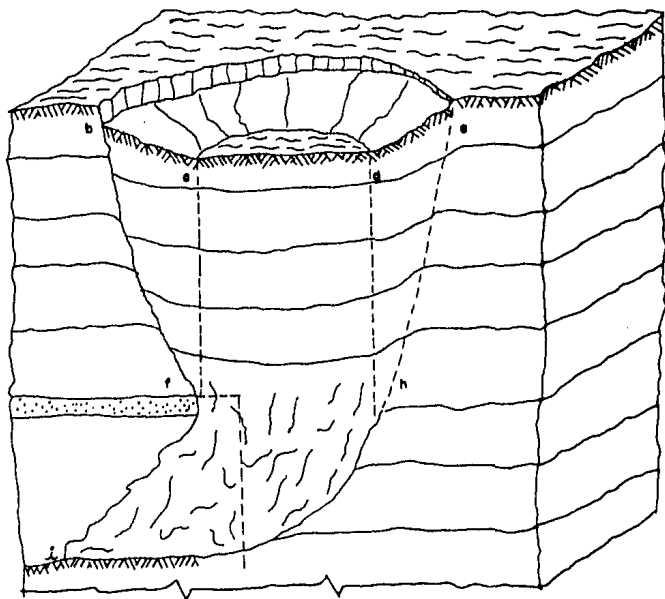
FALLA DEL FRENTE DE UN TUNEL EN SUELO INESTABLE.
